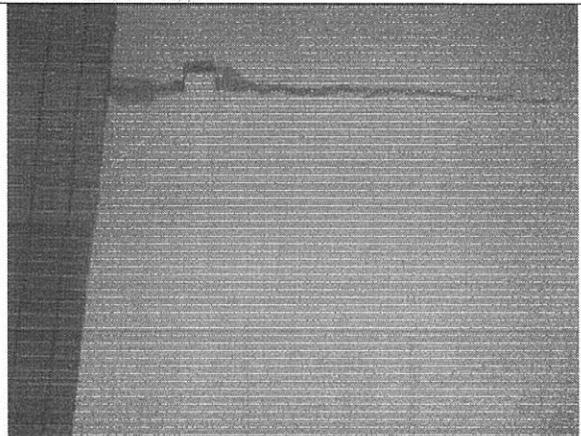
Agrietamiento en muro del costado sur del segundo piso
